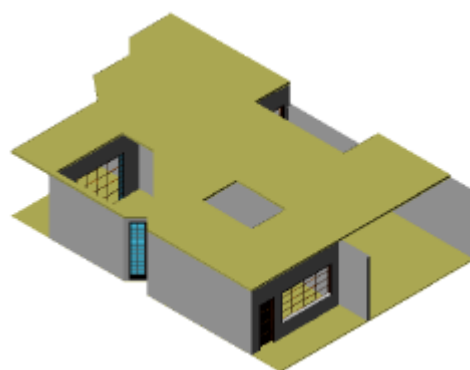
Aspecto da edificação após o desenho do piso do segundo pavimento.
